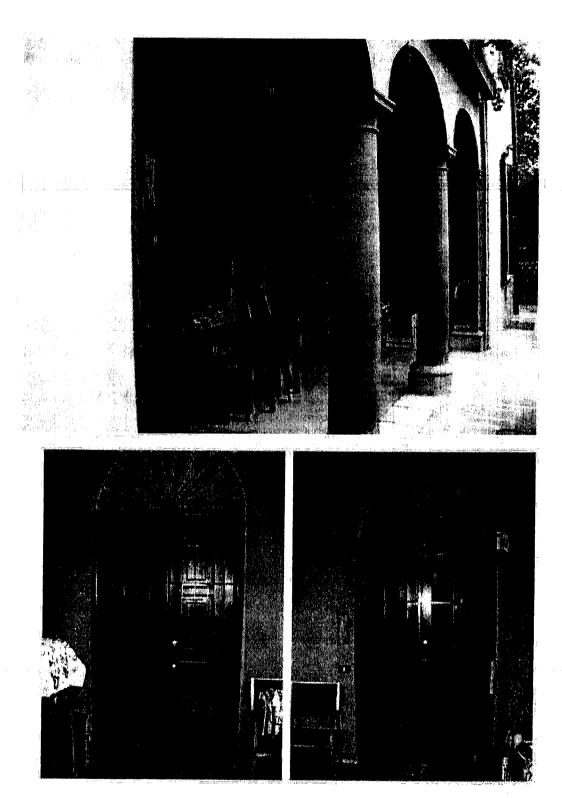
, 13 e 14 - Rilievo esterno – Il portico e le porte di accesso agli alloggi, nel dettaglio l'accesso secondario a sinistra e il principale a destra.
